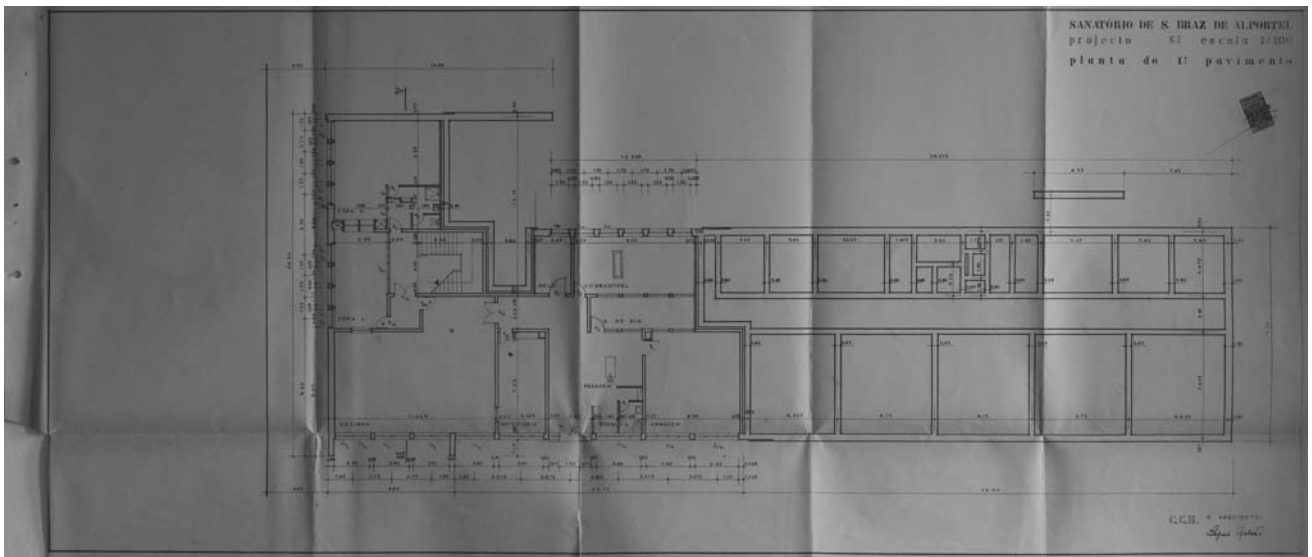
Planta do 1º. Pavimento. DGCH, s/r.
